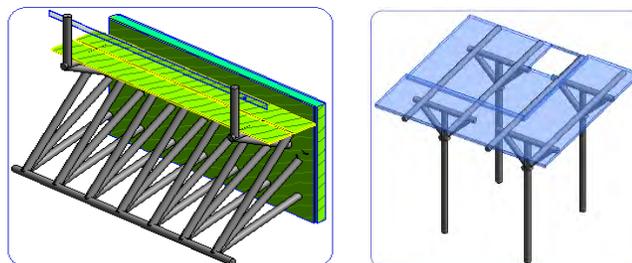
Apuntalado de elementos verticales y horizontales.
